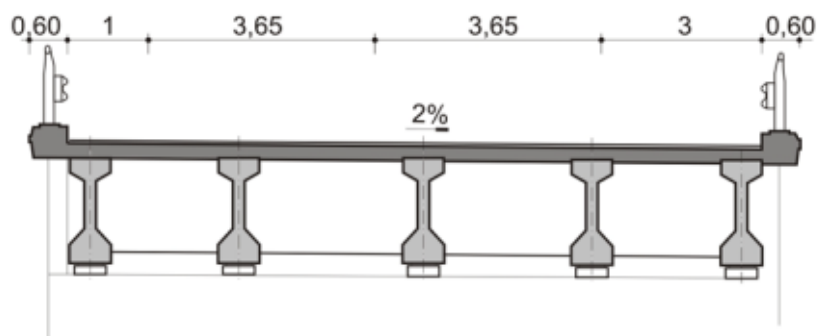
Sección transversal del puente de dos calzadas sobre la vía principal.
